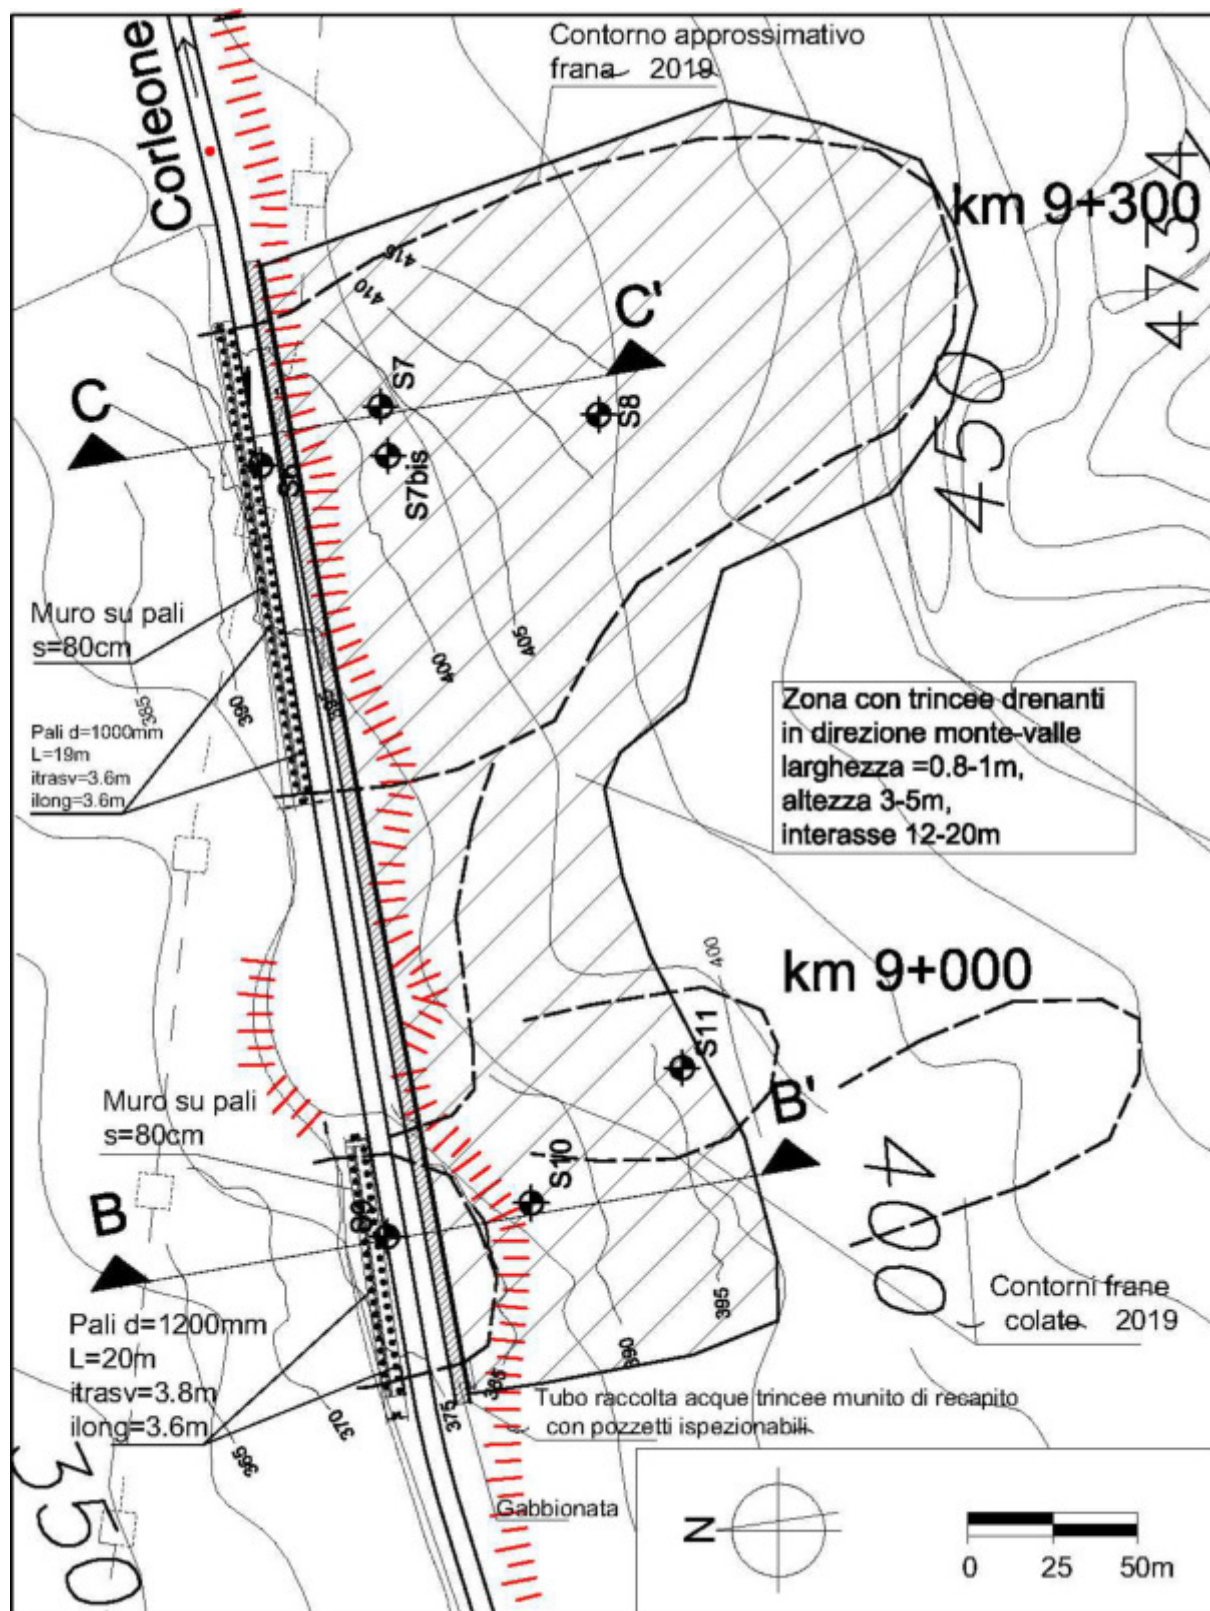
Dissesto dal km 9+000 al km 9+300. Planimetria schematica degli interventi da realizzare.
